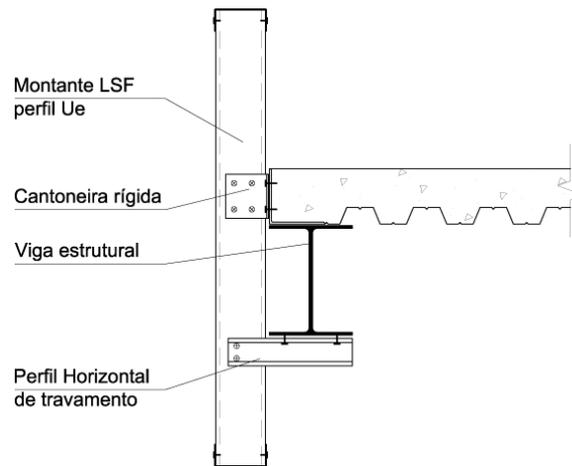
Painel janela a janela com apoio secundário com perfil horizontal
